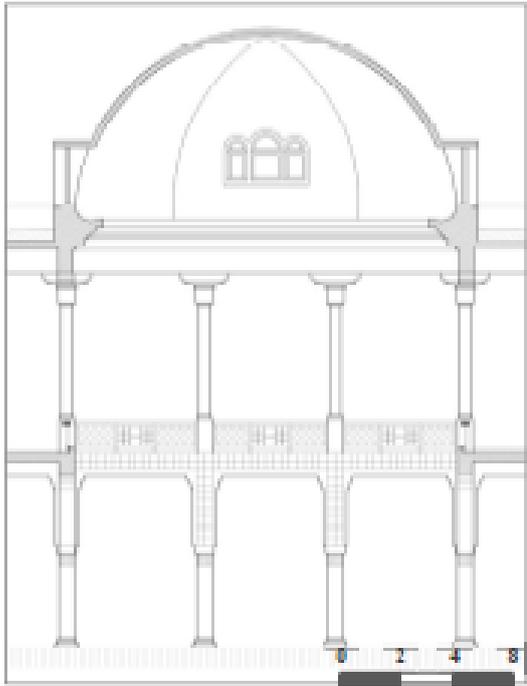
Coupe transversal sur la galerie et le hall du public serviced'état civil. Source : Auteur
